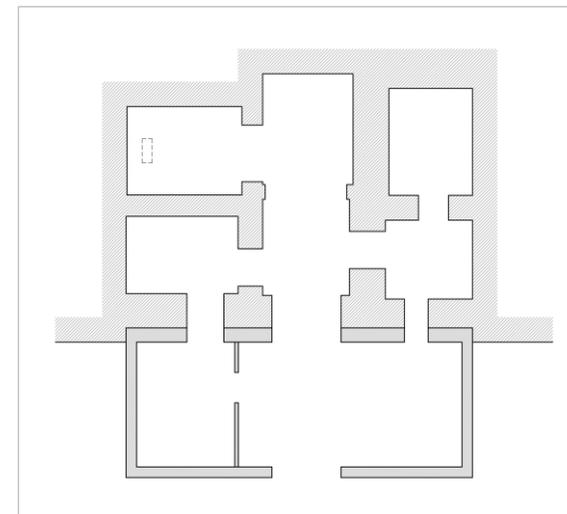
TIPO 2Ba con una segunda planta construida sobre el terreno. Cueva 17_01_04 de Monóvar
